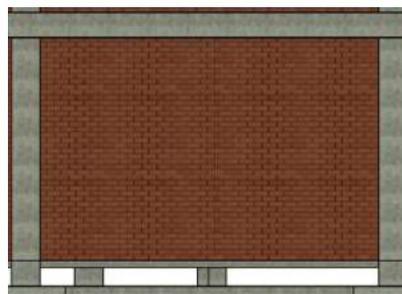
Muro en mampostería confinada (Fuente: Archivo rvt propio).
